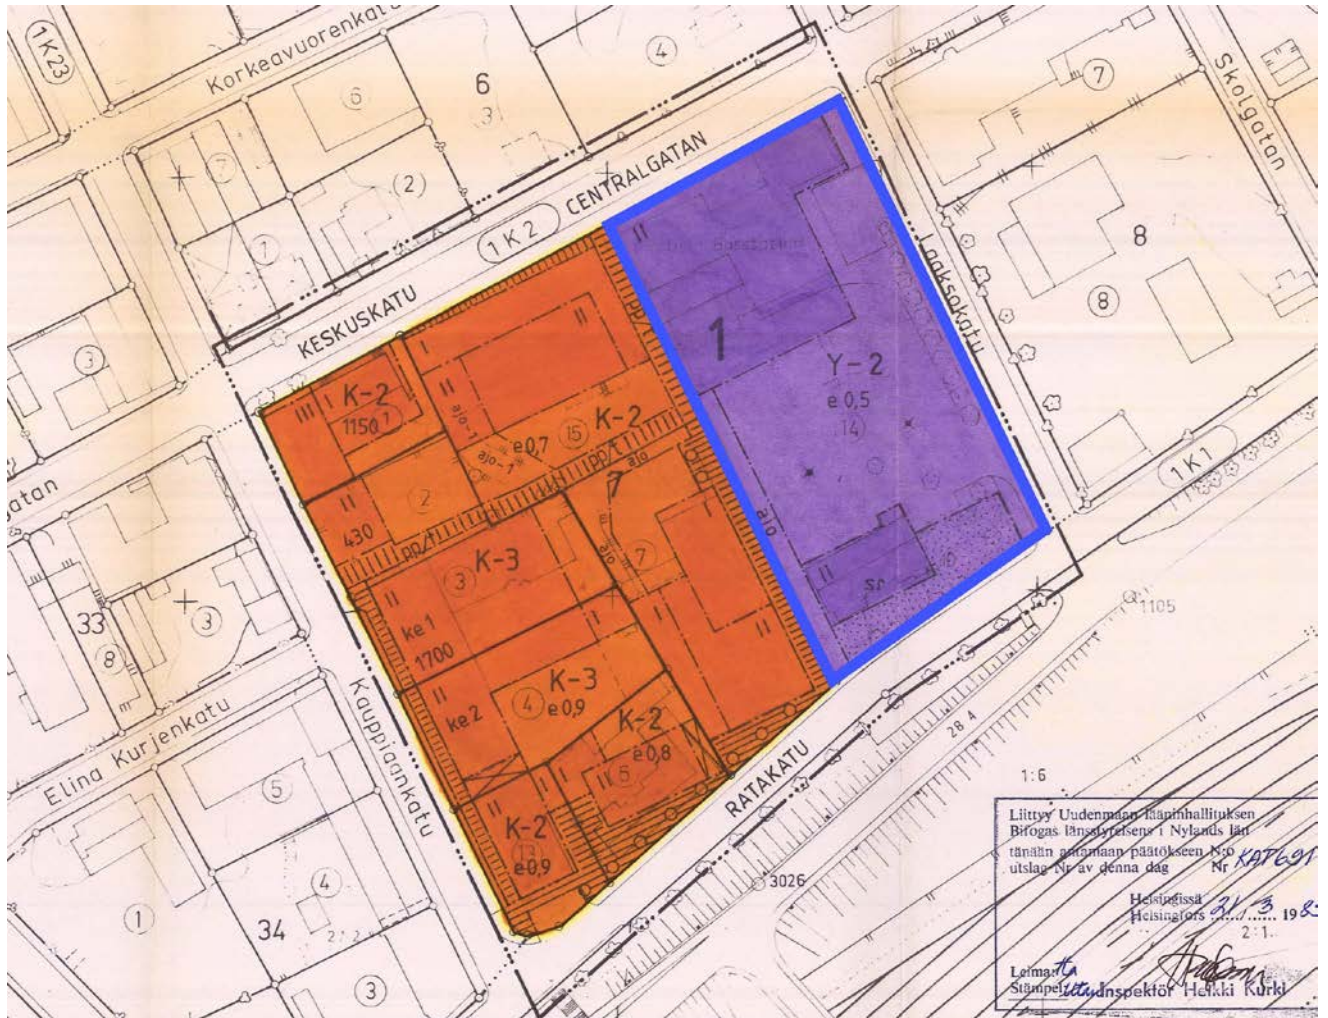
Utdrag ur detaljplan 176-100. Planområdets avgränsning med blå linje.
